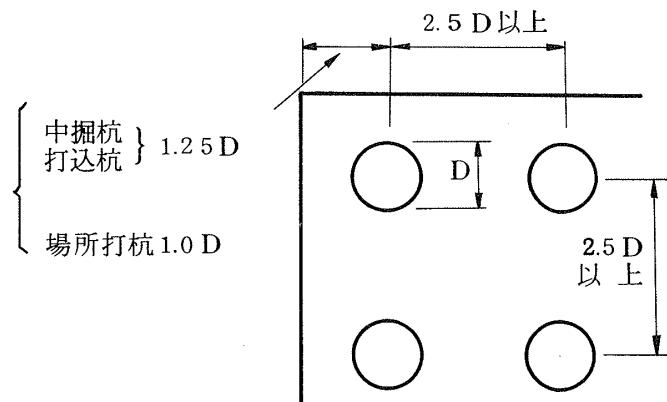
杭の最小中心間隔¹³⁰⁾
